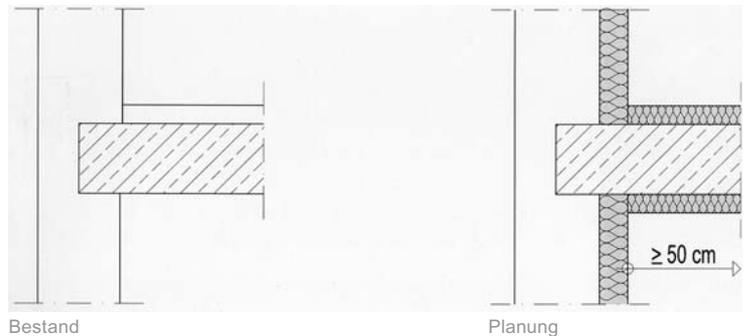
Innendämmung einer einbindenden Geschossdecke
